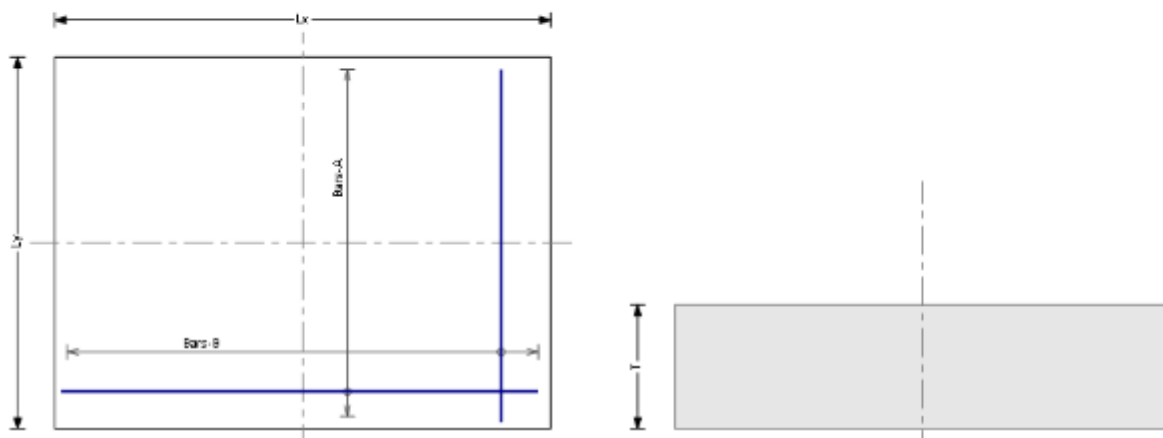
Planta y elevación de la zapata aislada, análisis No lineal
